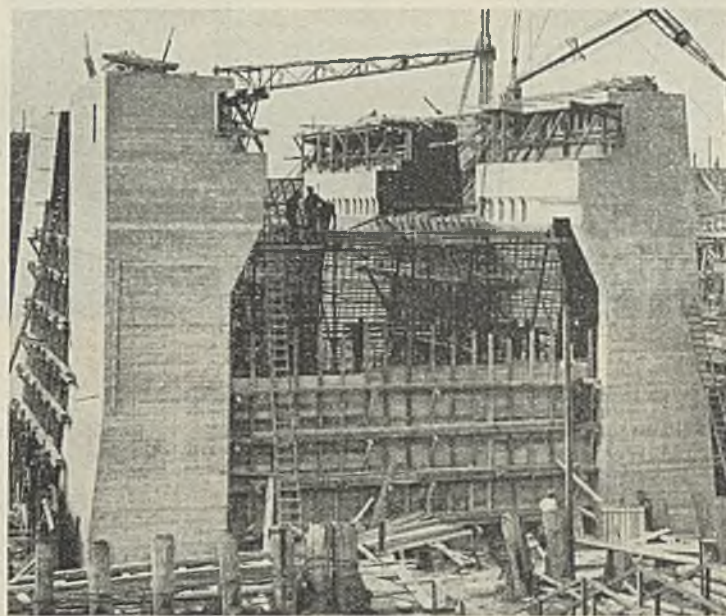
Außenhaupt. Torkammertrog, Abschlußwand.
